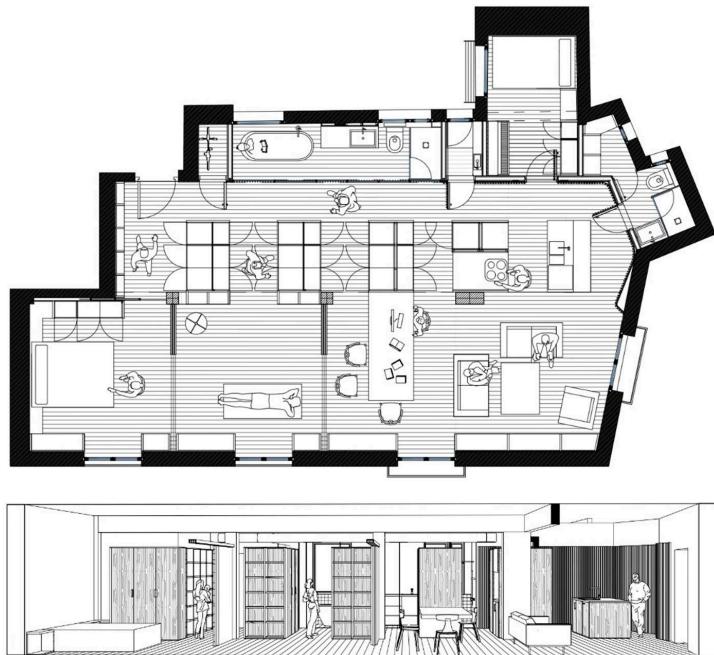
Planta y sección de proyecto de vivienda para una persona sola.
